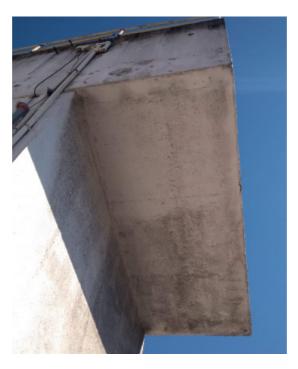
Laje em balanço da caixa d'água vistoriada.
